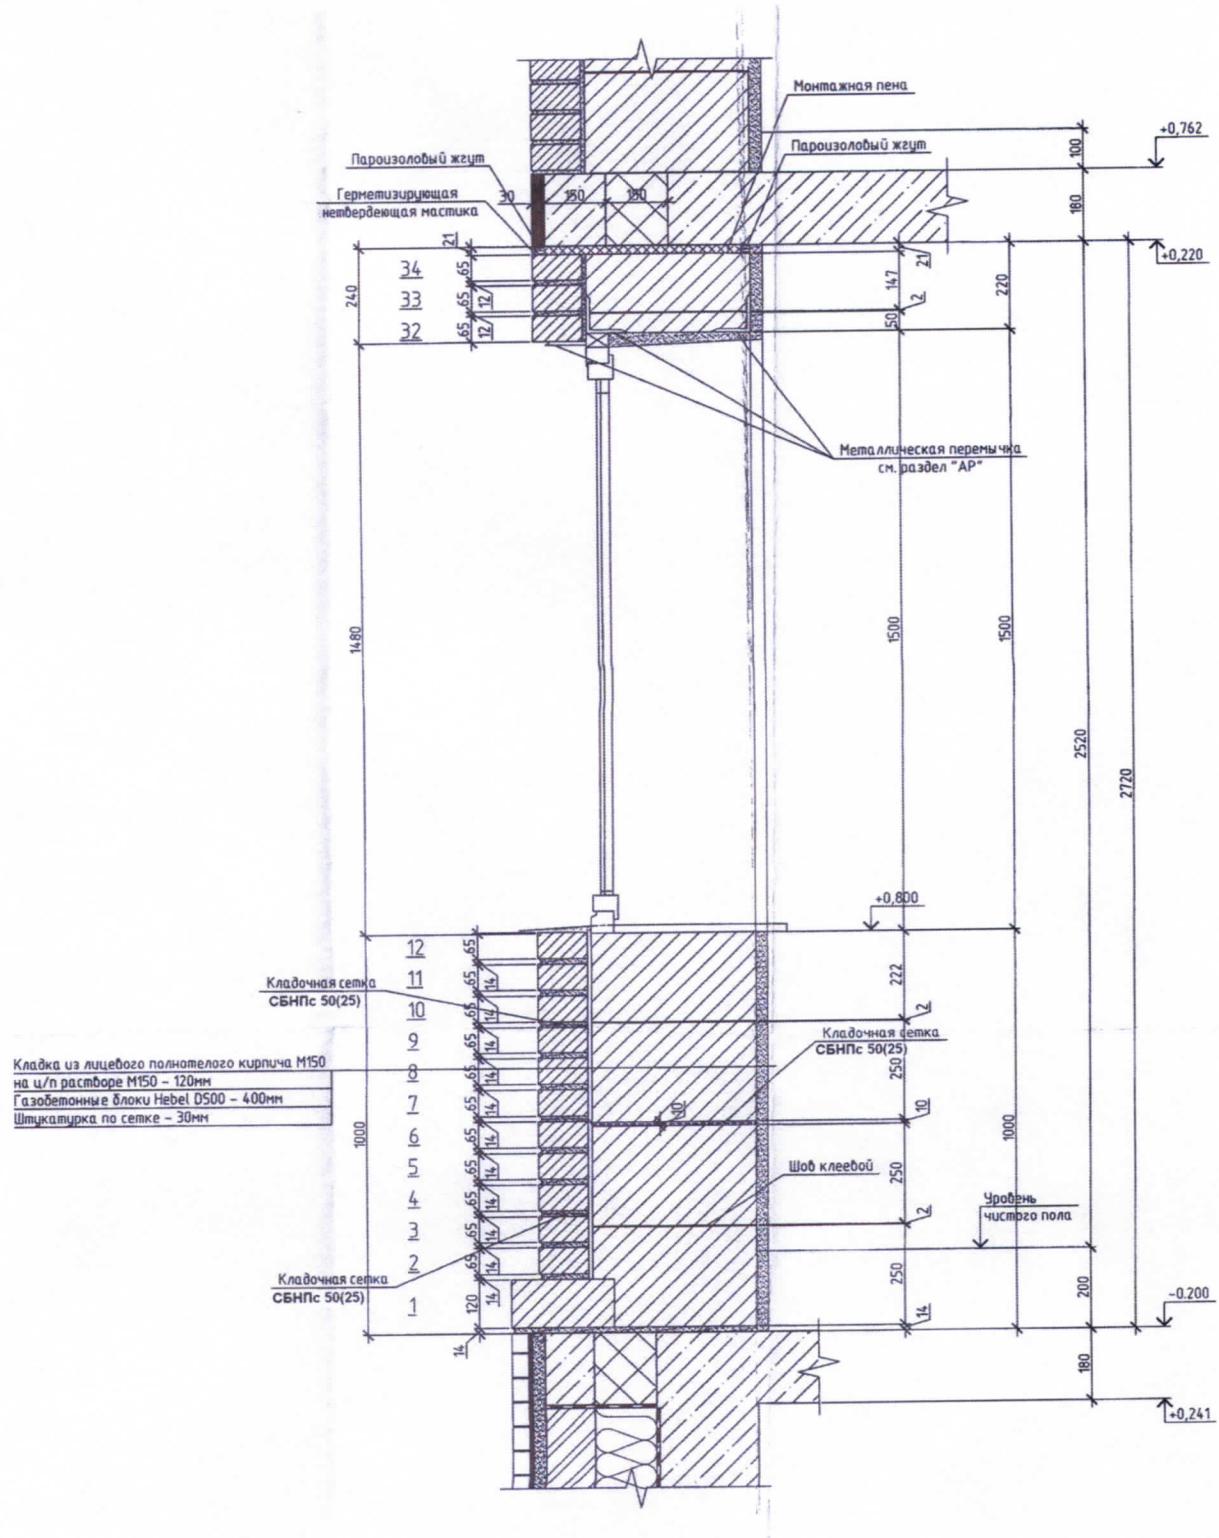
Сечение по наружной стене в зоне оконного проема
